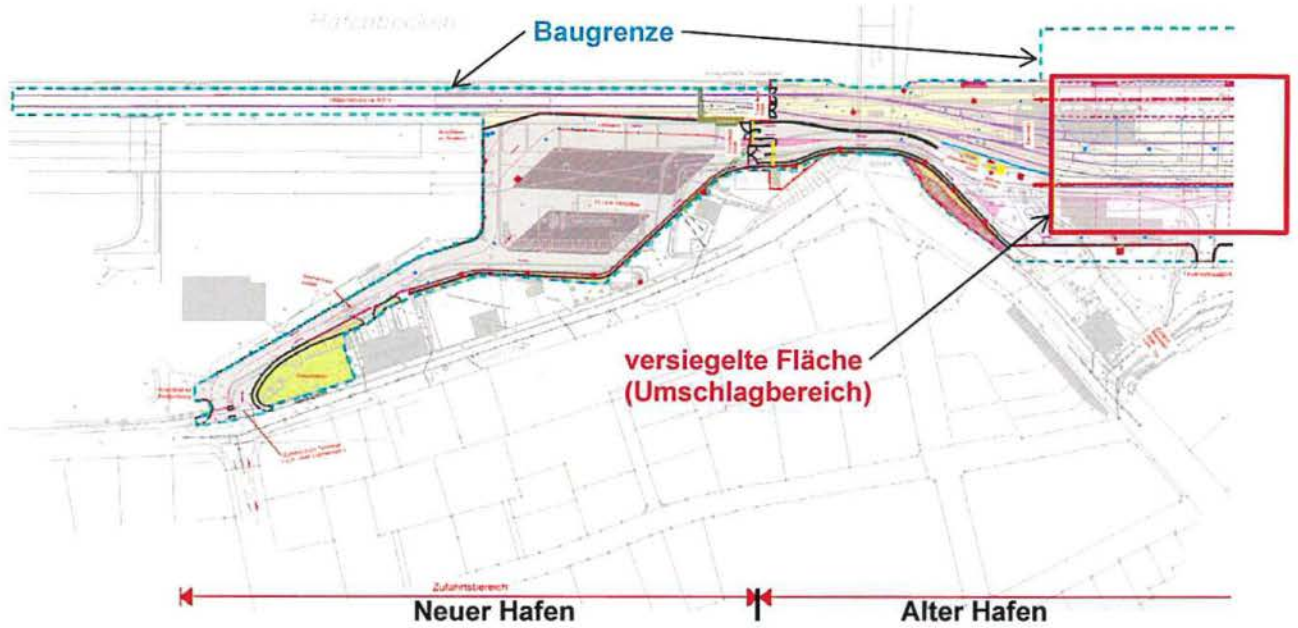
Ausschnitt Übersichtslageplan (duisport 05.05.2014) – westlicher Teil
